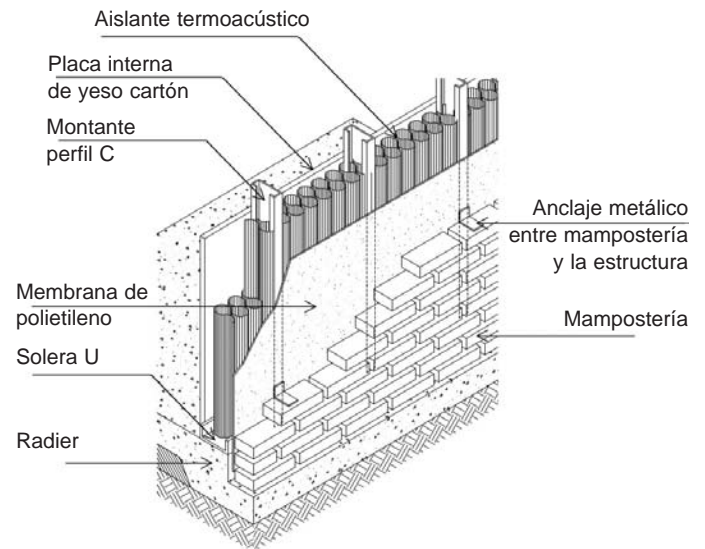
Diseño esquemático de cerramiento de mampostería de paneles en LSF.
